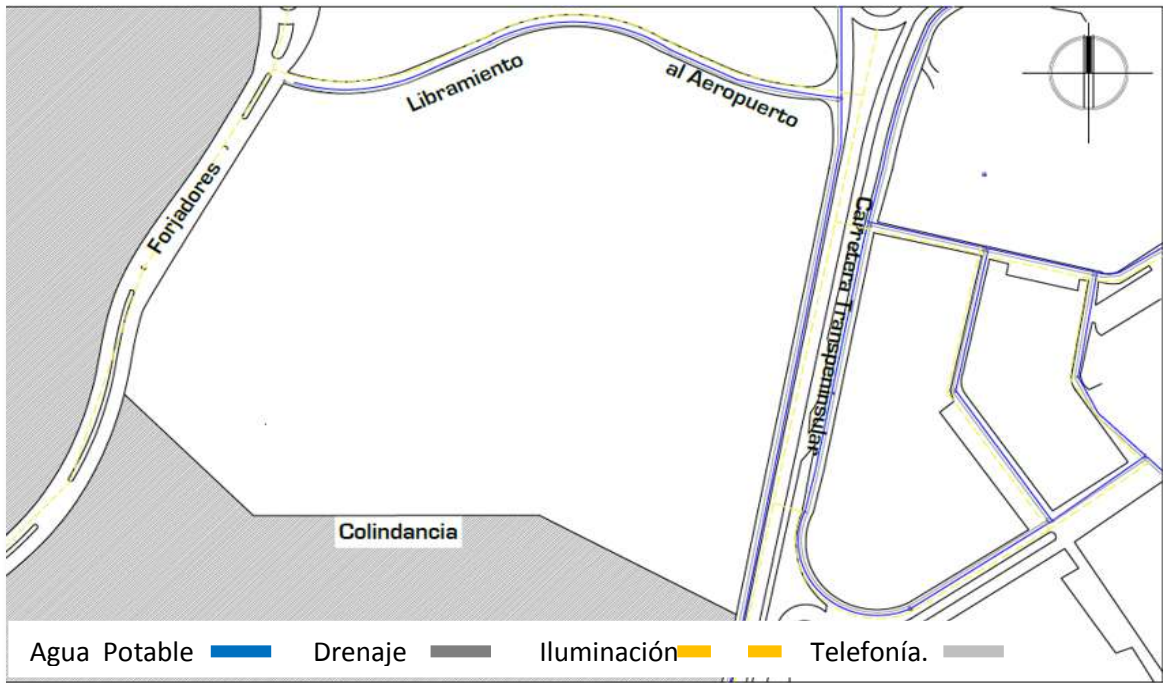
Plano de infraestructura de los cabos. Fuente: Plan de desarrollo urbano.
